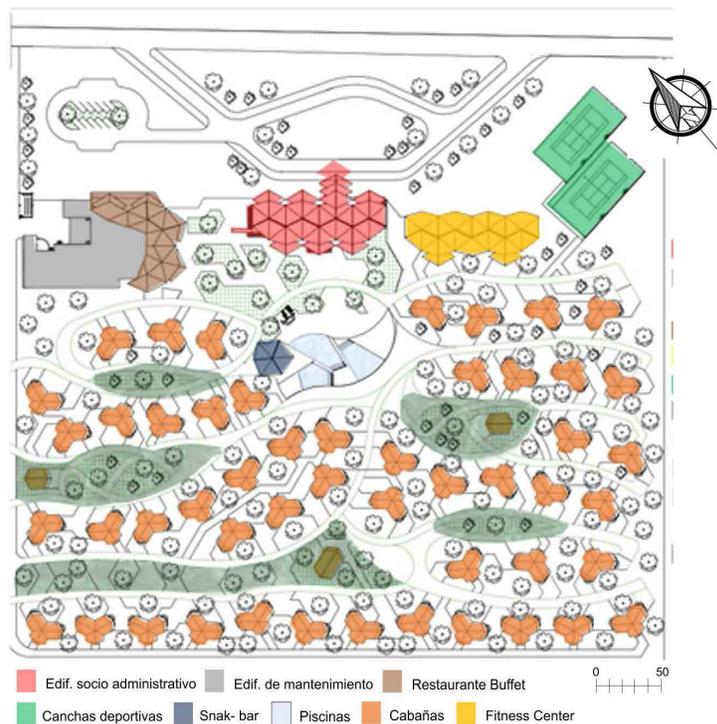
Plan general de la villa turística en Salto y Ganuza. Fuente: autores, 2018.
